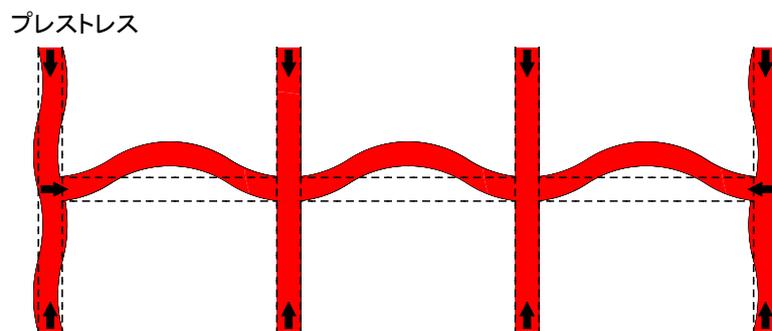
施工時、プレストレス導入による架構のむくり（+）変形図
